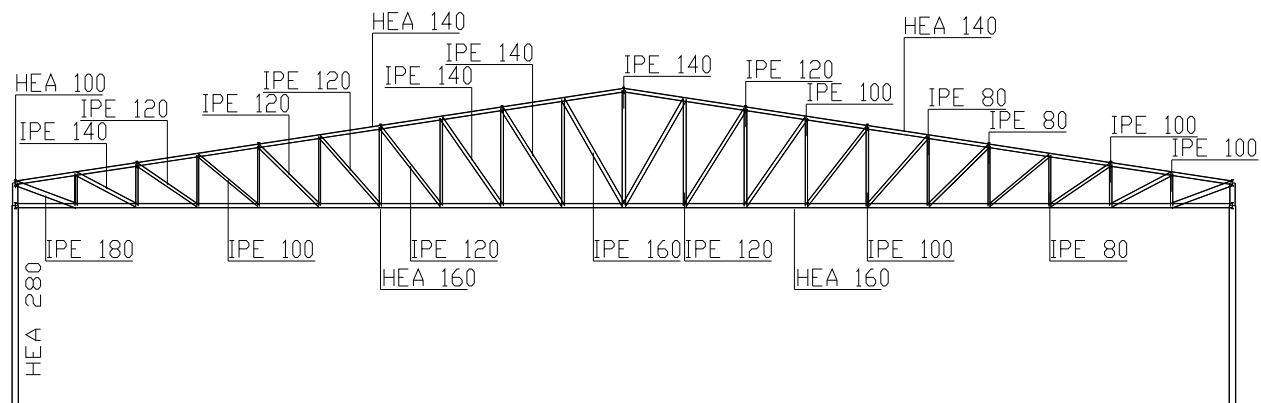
Pórtico com pilar de alma cheia, viga em treliça, vão de 50.00m, pilar em perfil com secção transversal HEA, viga em perfil com secção transversal HEA/IPE.
